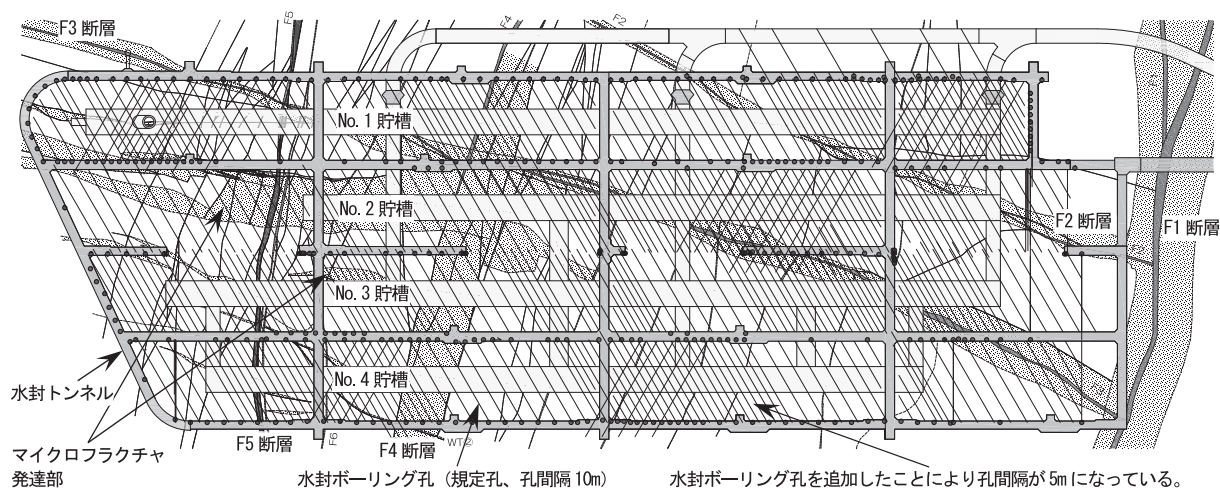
水封ボーリング孔の最終配置平面図（文献 5）の同図に加筆）
